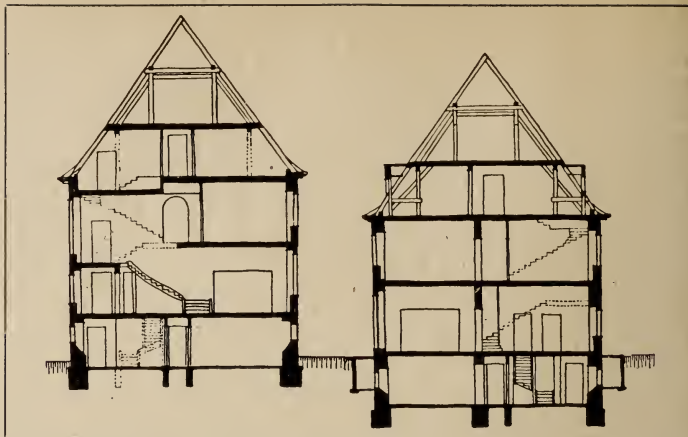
Haus mit bewohnbarem Kellergeschoß
